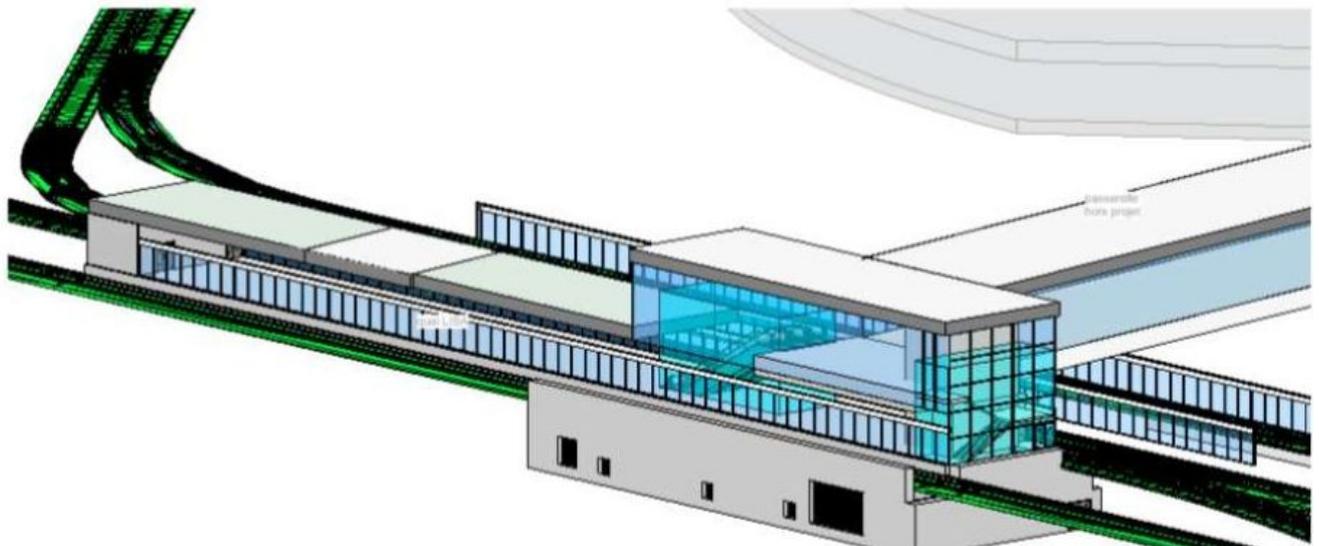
plan 3 D de la gare (source dossier du maître d'ouvrage)
